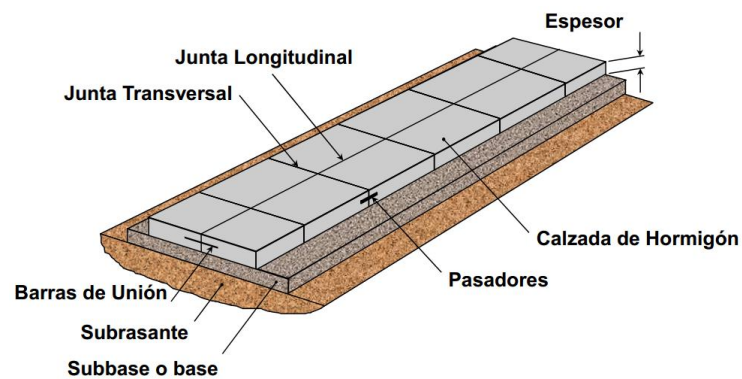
Estructura de pavimento rígido, (Calo, 2012).
